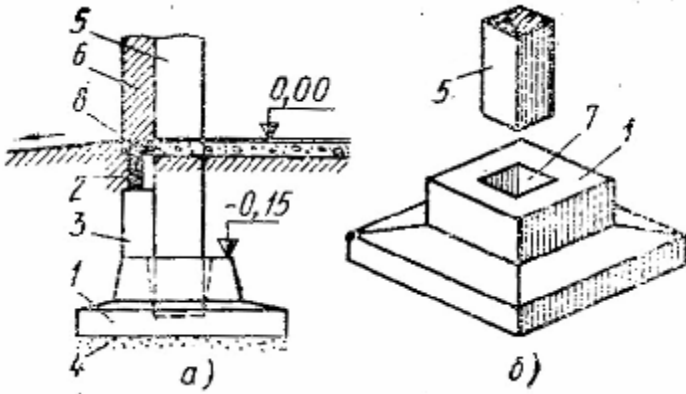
Сборный железобетонный фундамент стаканного типа:
